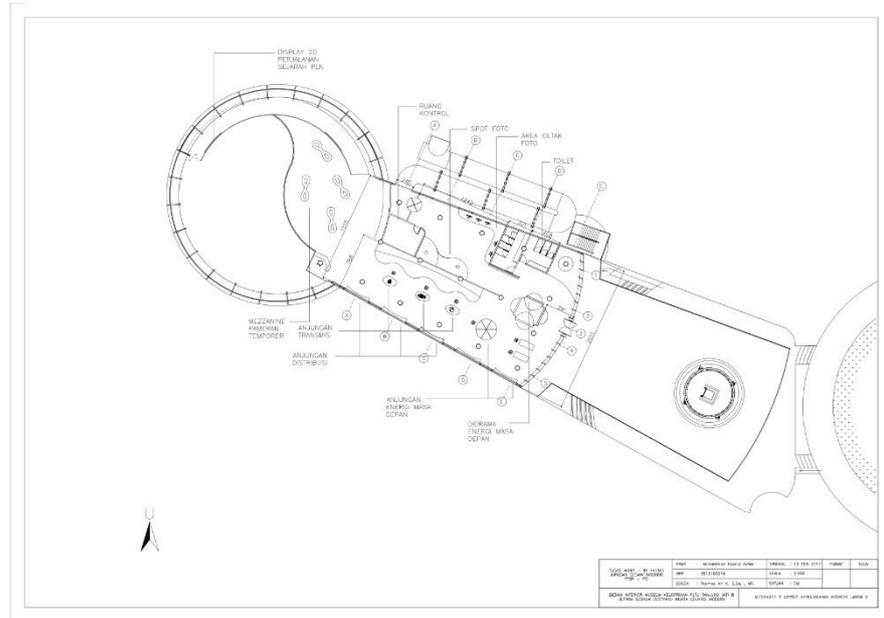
Alternatif layout 1 pada lantai 2.
